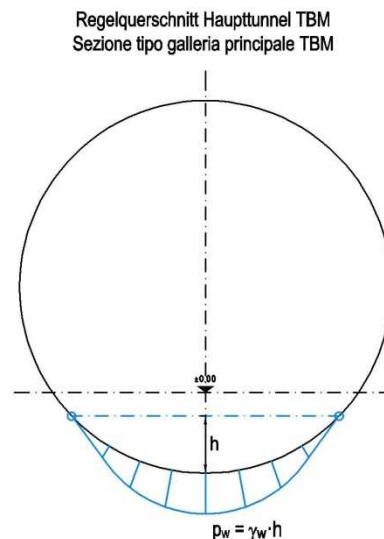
Pressione idrostatica - Sezione tipo drenata
